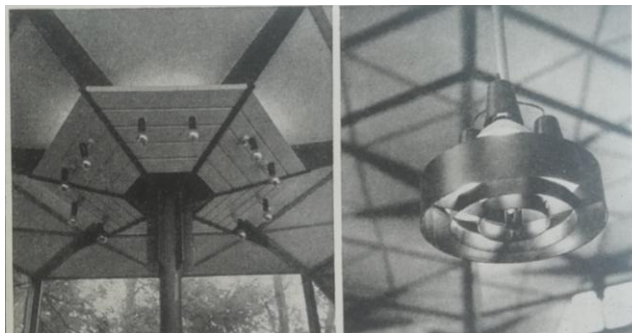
Dos tipos de fijación al techo (ceiling fitting) para la iluminación interior del pabellón. Imagen publicada en la revista *Architectural Review*, n.739, agosto 1958.
